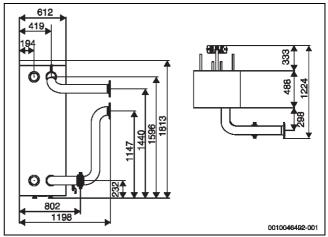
Wärmetauschergruppe für 2-Kessel-Kaskade  $2 \times 350$  kW,  $2 \times 400$  kW,  $2 \times 500$  (Maße in mm)
